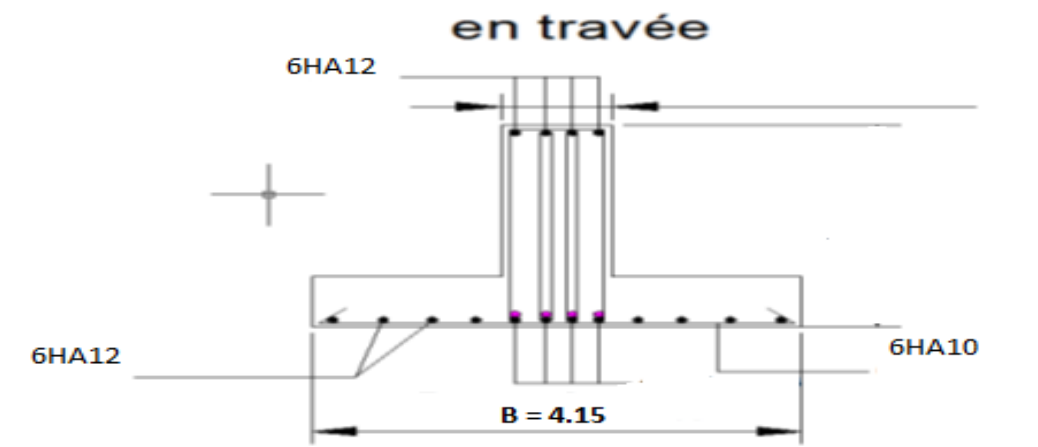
ferrailage de la semelle filante sous poteau en travée
